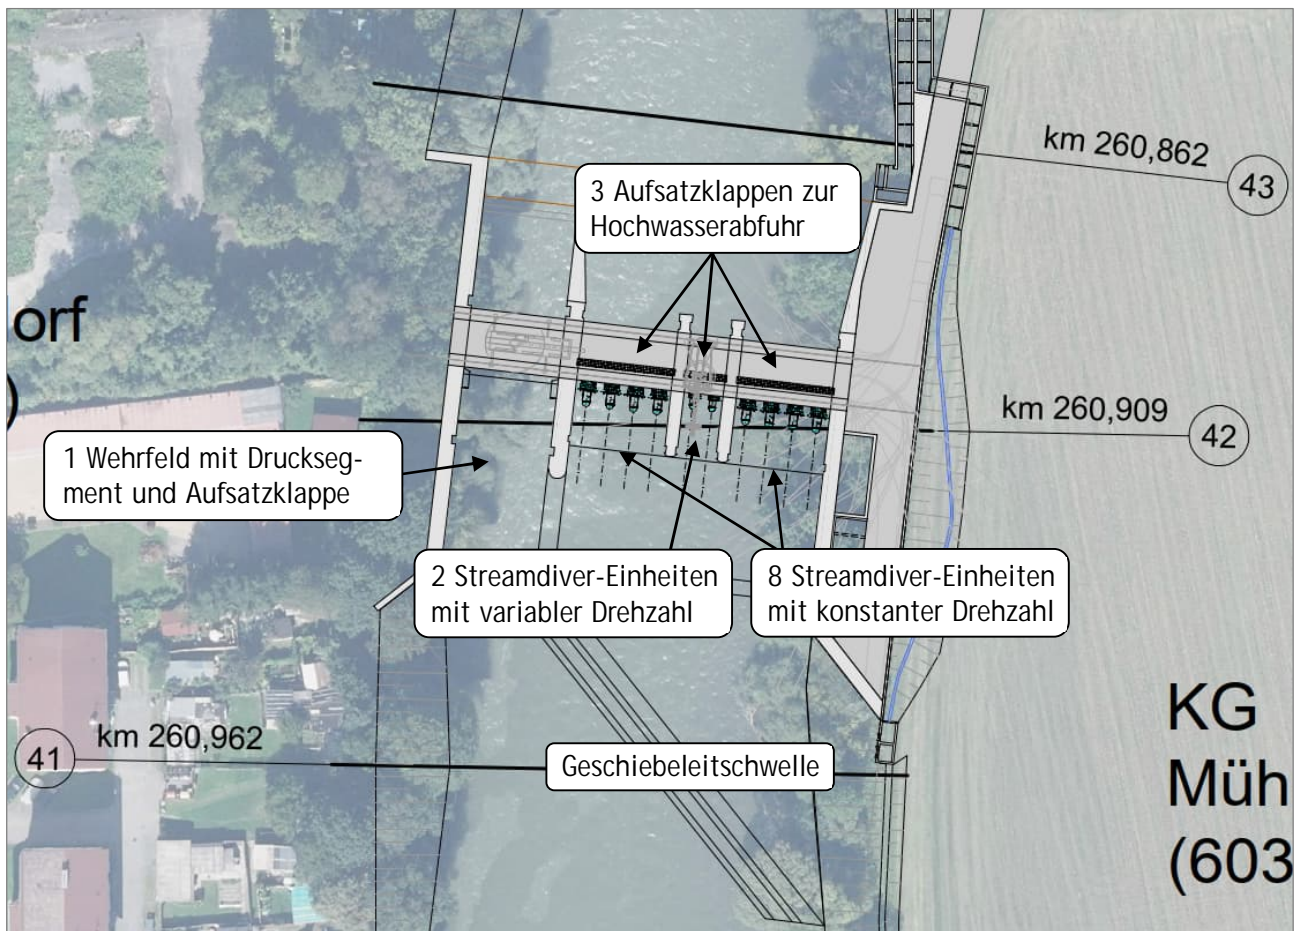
Lageplan der Design- und Technologievariante Überströmkraftwerk (Planstand 2021)
